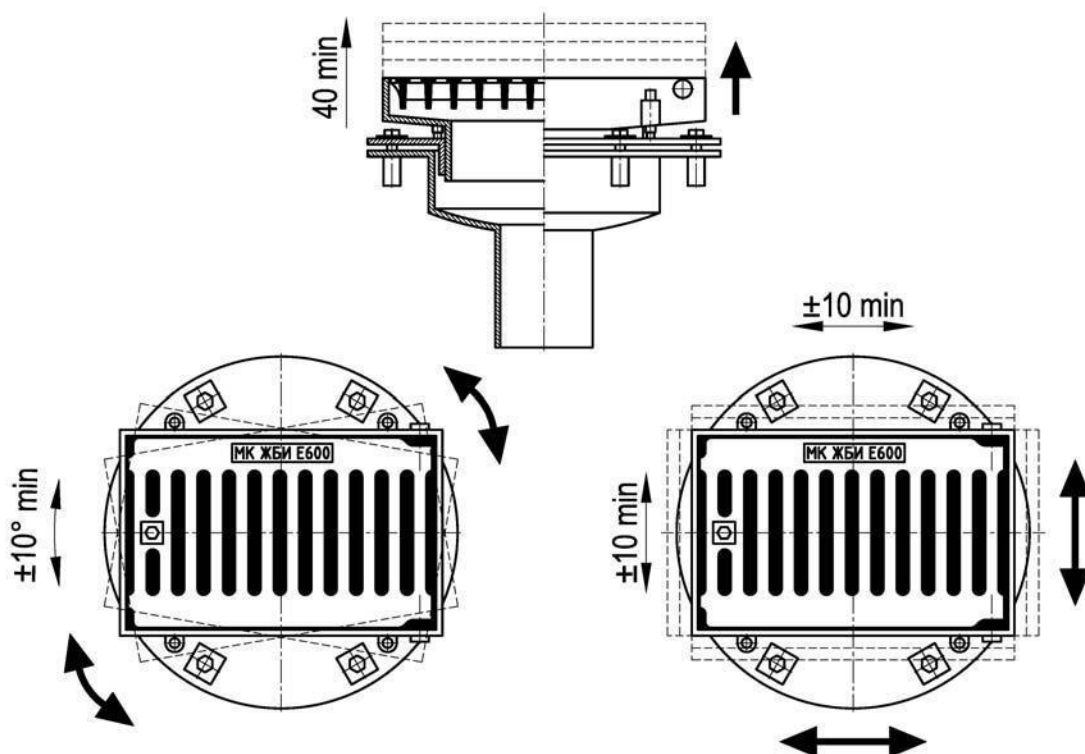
Схема монтажных регулировок мостового трапа для железобетонных строений.
